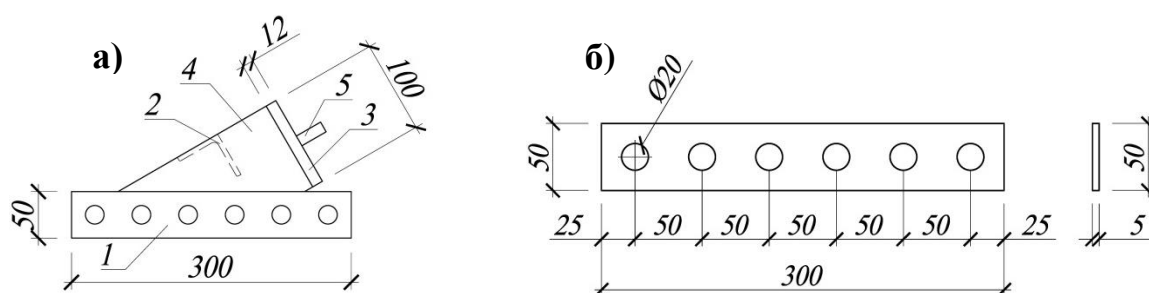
Конструкция стальной опорной части (а) и схема расположения отверстий во вклеиваемой части плоского стержня (б): 1 – вклеиваемый стальной плоский стержень; 4 – распорка; 3 – опорная площадка; 4 – фасонка; 5 – шкант
